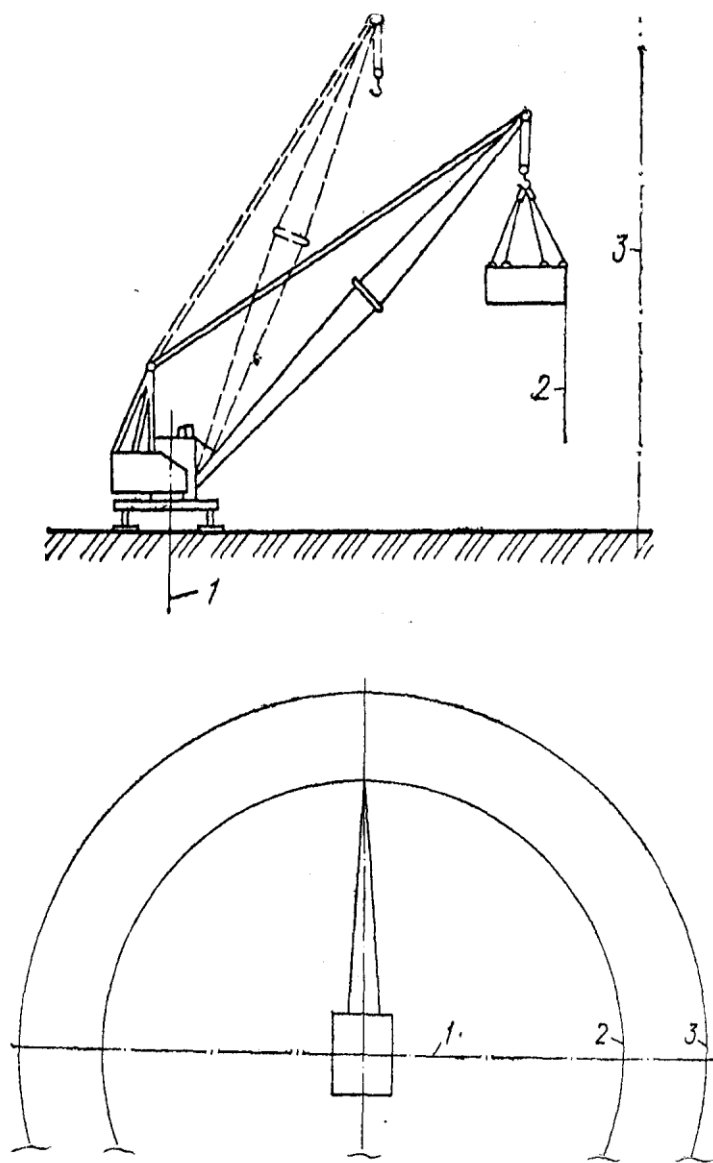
Опасные зоны при работе стреловых самоходных кранов:
